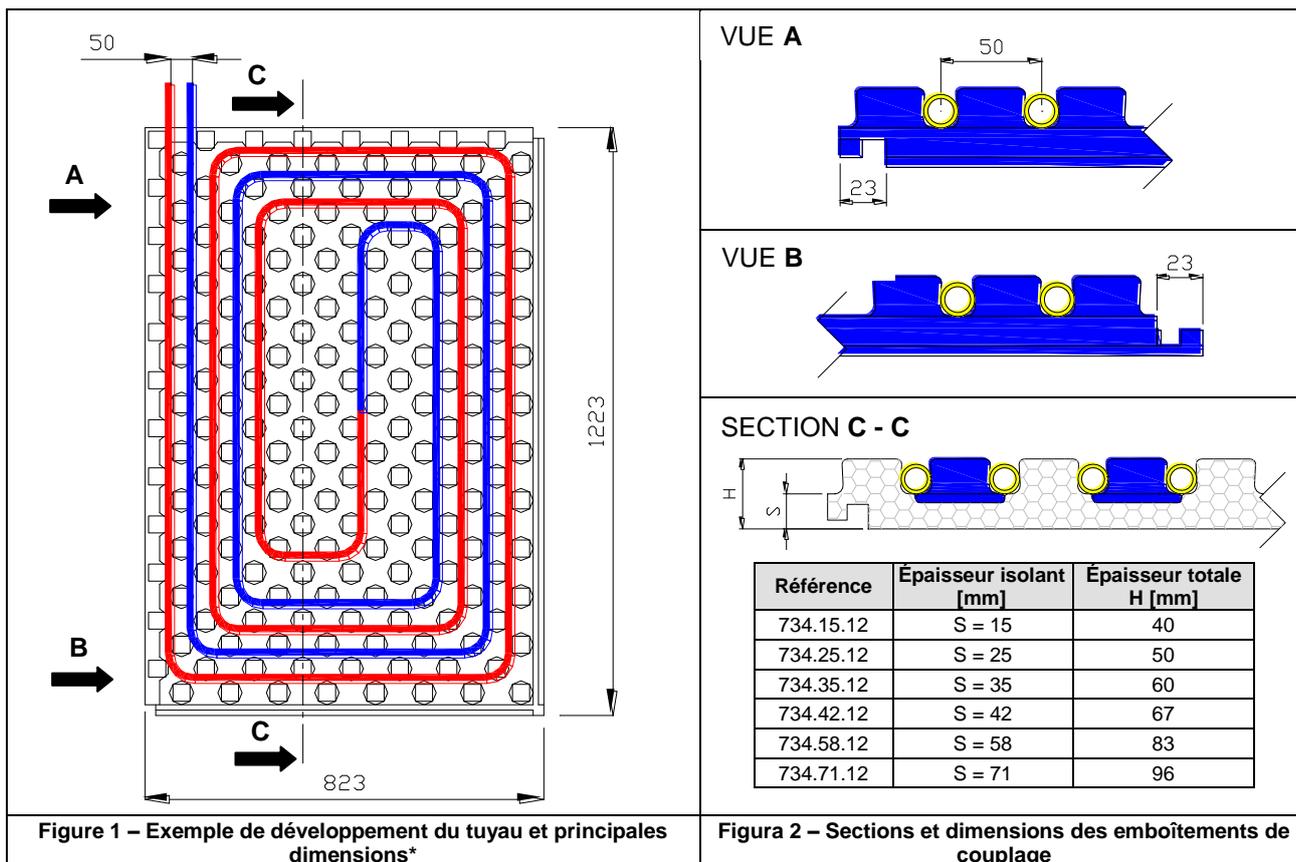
Exemple de développement du tuyau et principales dimensions
